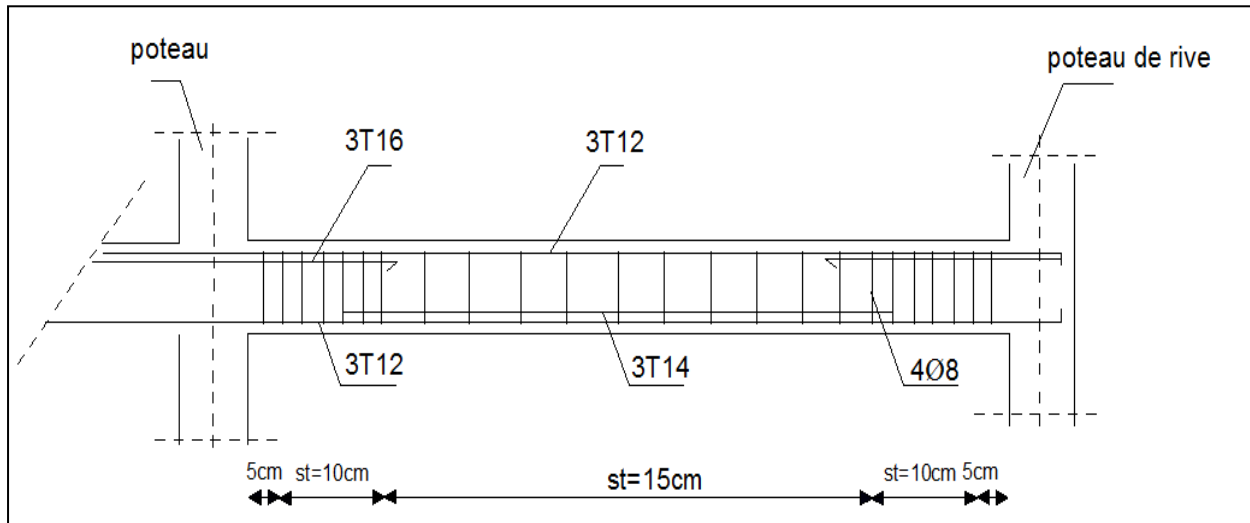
Schéma de ferrailage des poutres principales étage commercial.
